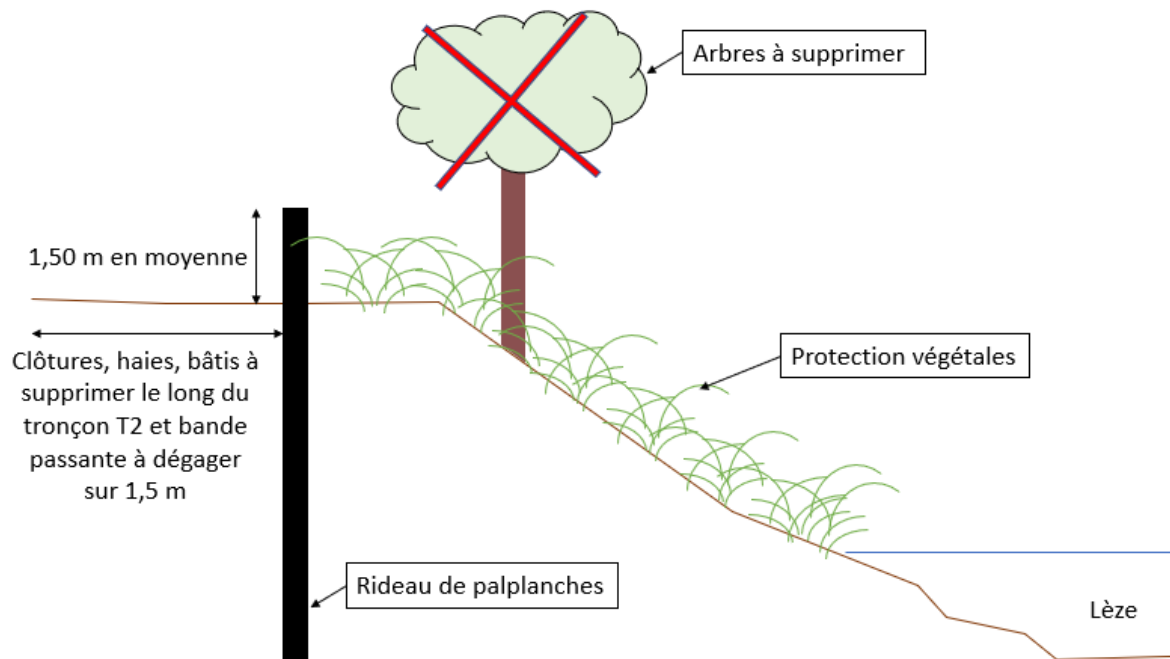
Coupe type du profil en remblai des solution A2 et B2
